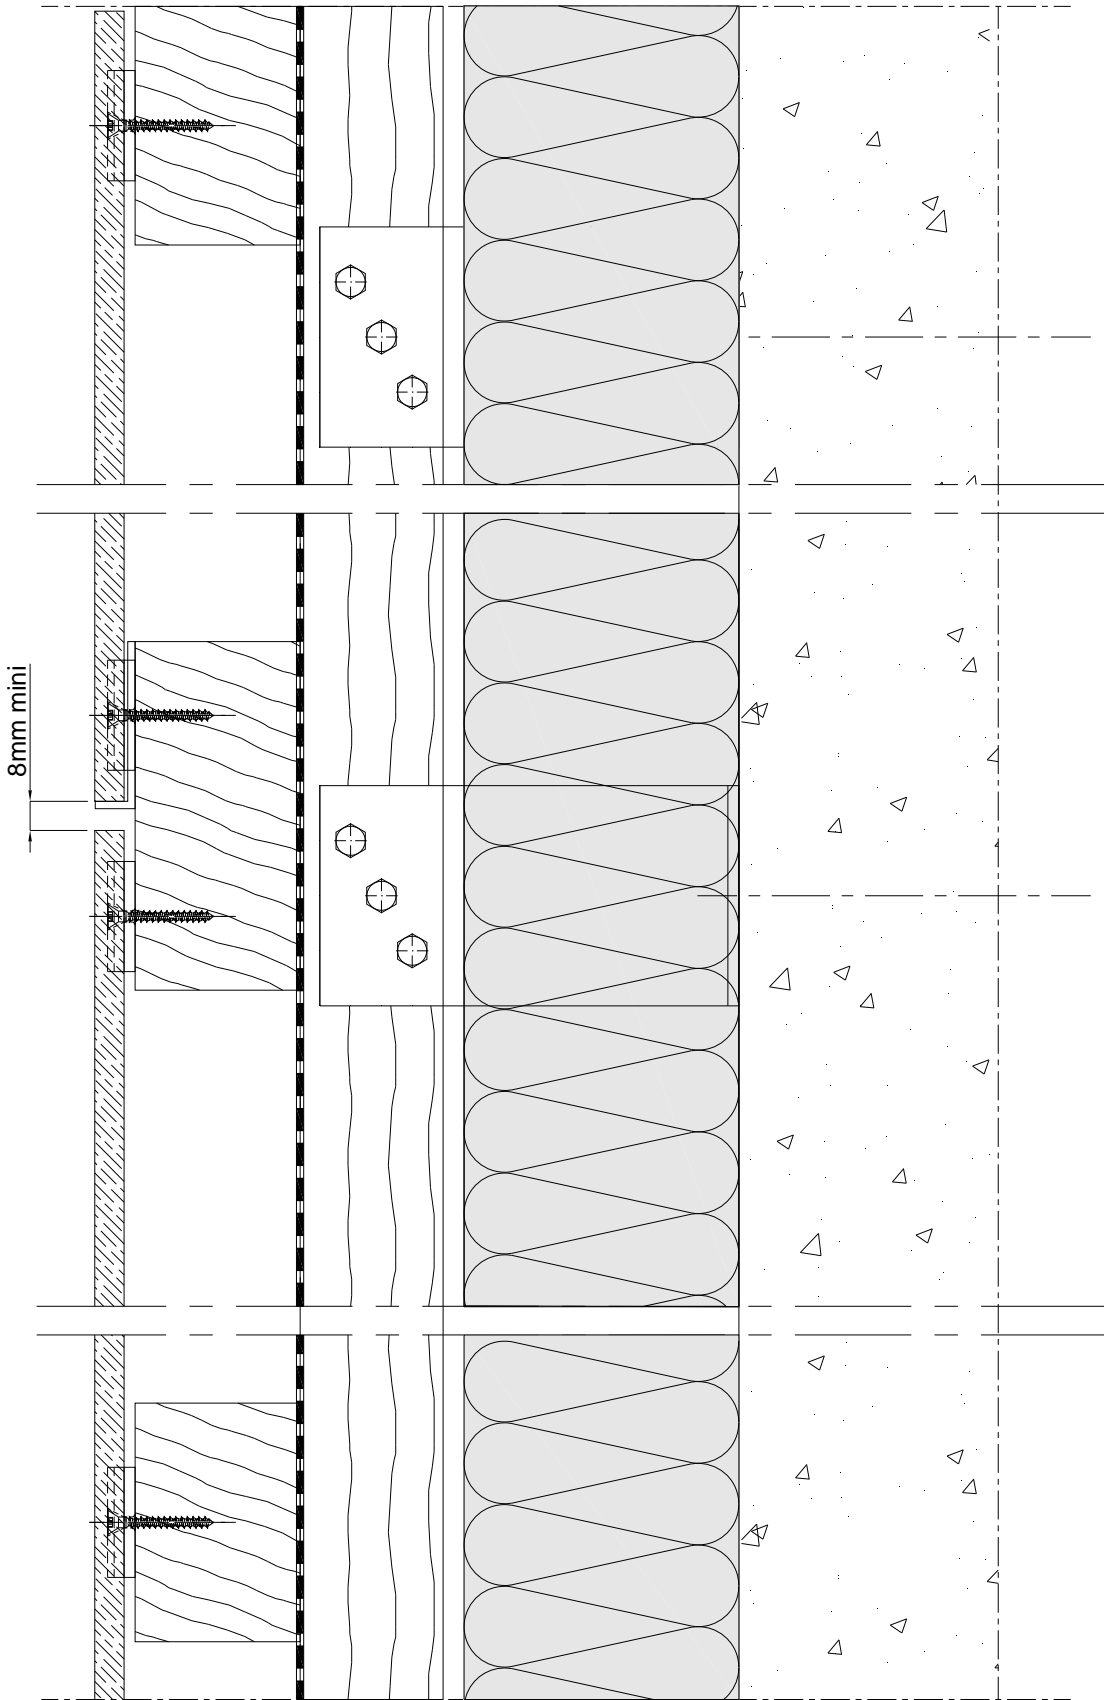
Pose verticale – joint horizontal (coupe verticale)
